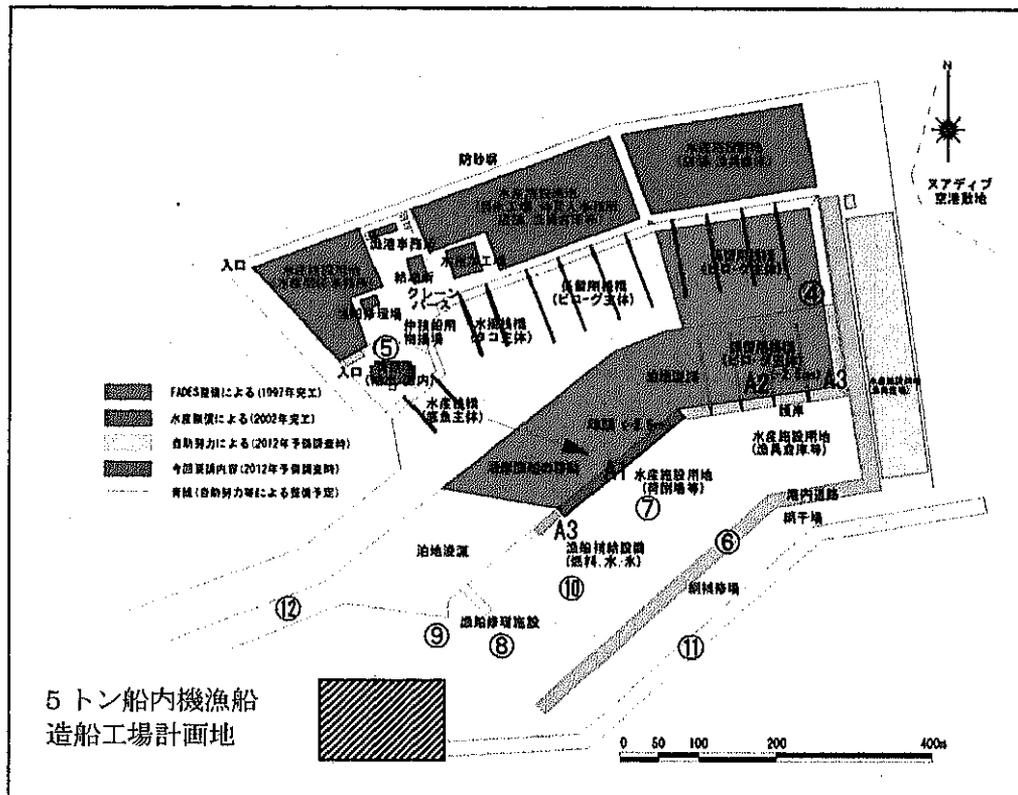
(1) ヌアディブ漁港拡張整備計画の要請施設配置図
